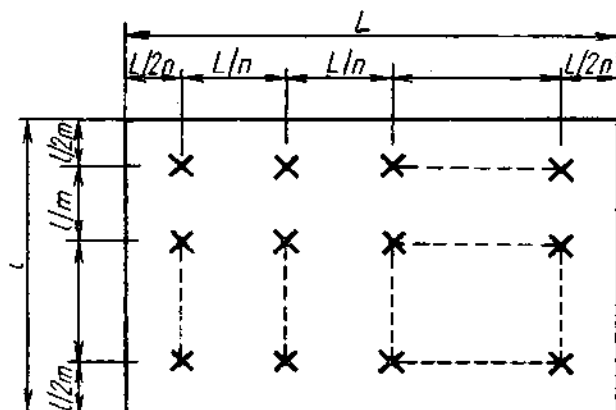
Amplasarea simetrică în plan a corpului de iluminat
